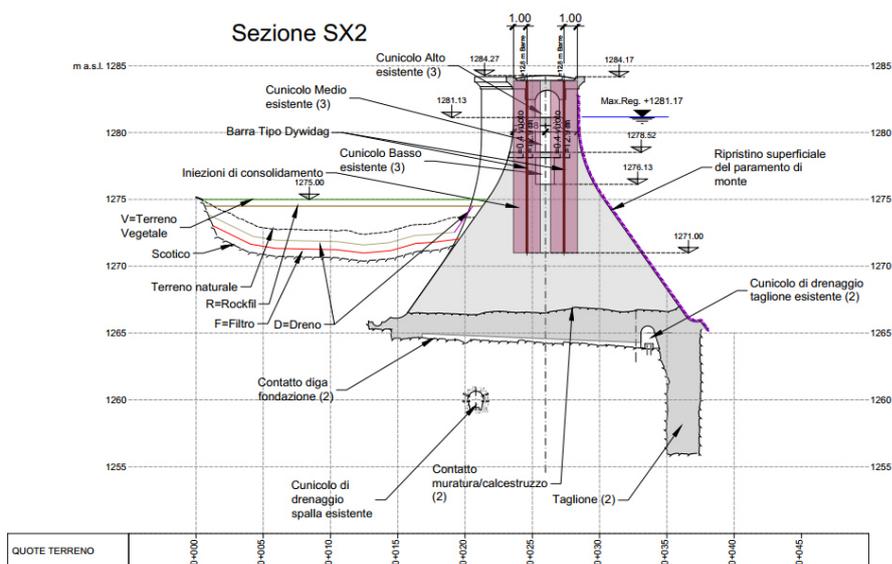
Iniezioni dal coronamento dello sbarramento secondario, sezione trasversale
